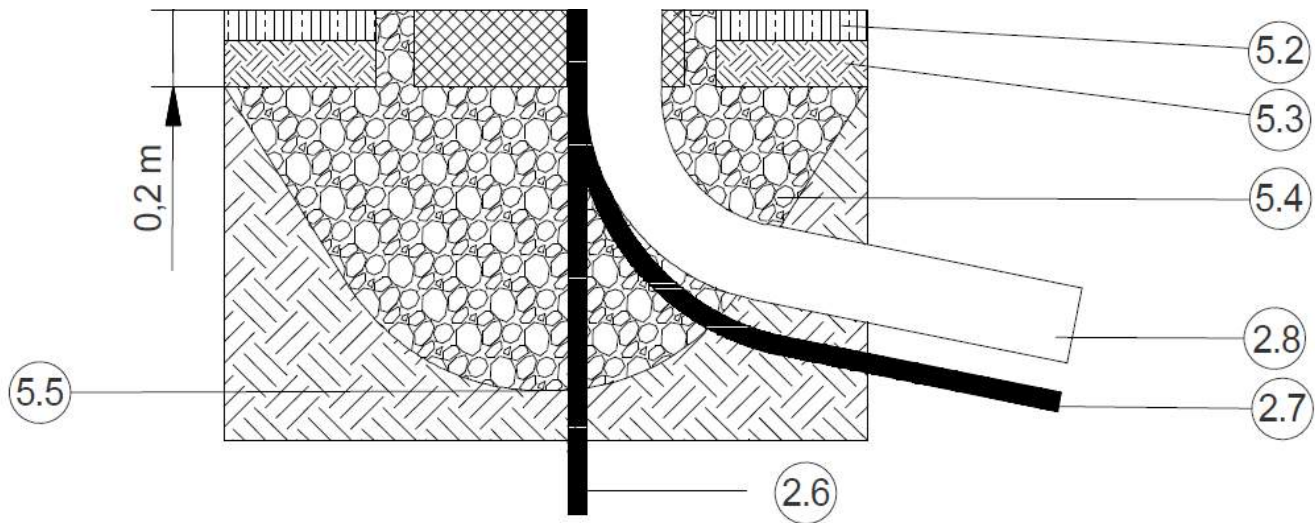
Plan de fondation M Flex et System M Comfort avec lit de gravier
